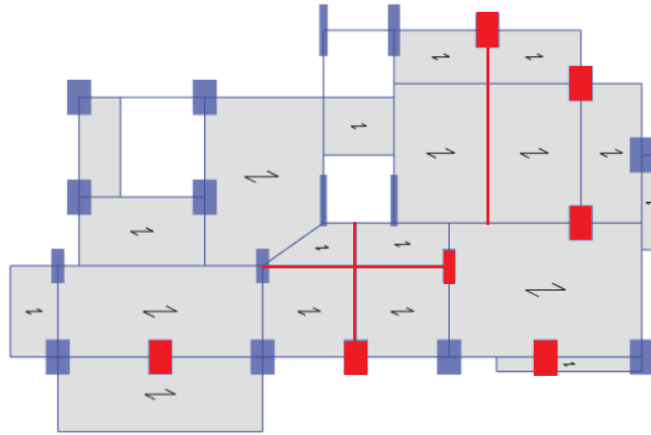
Columnas y vigas del piso “tipo” NTC-Estático.
